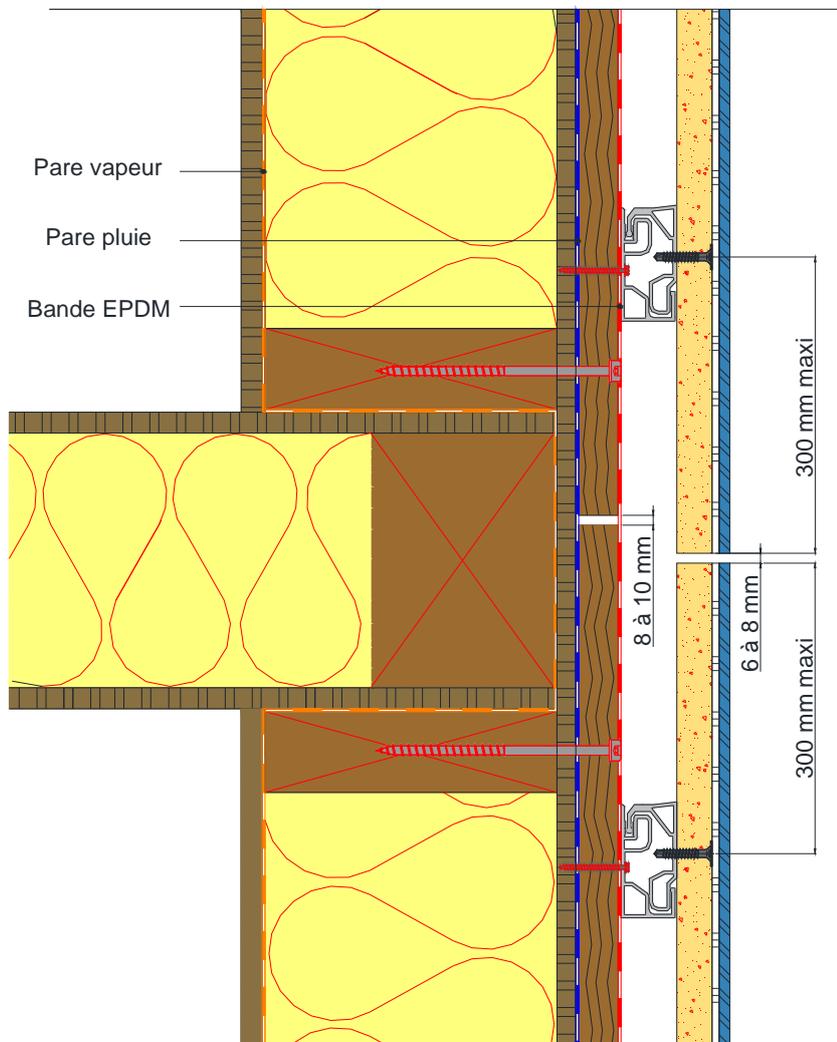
Pose sur COB - fractionnement de l'ossature au droit des planchers
